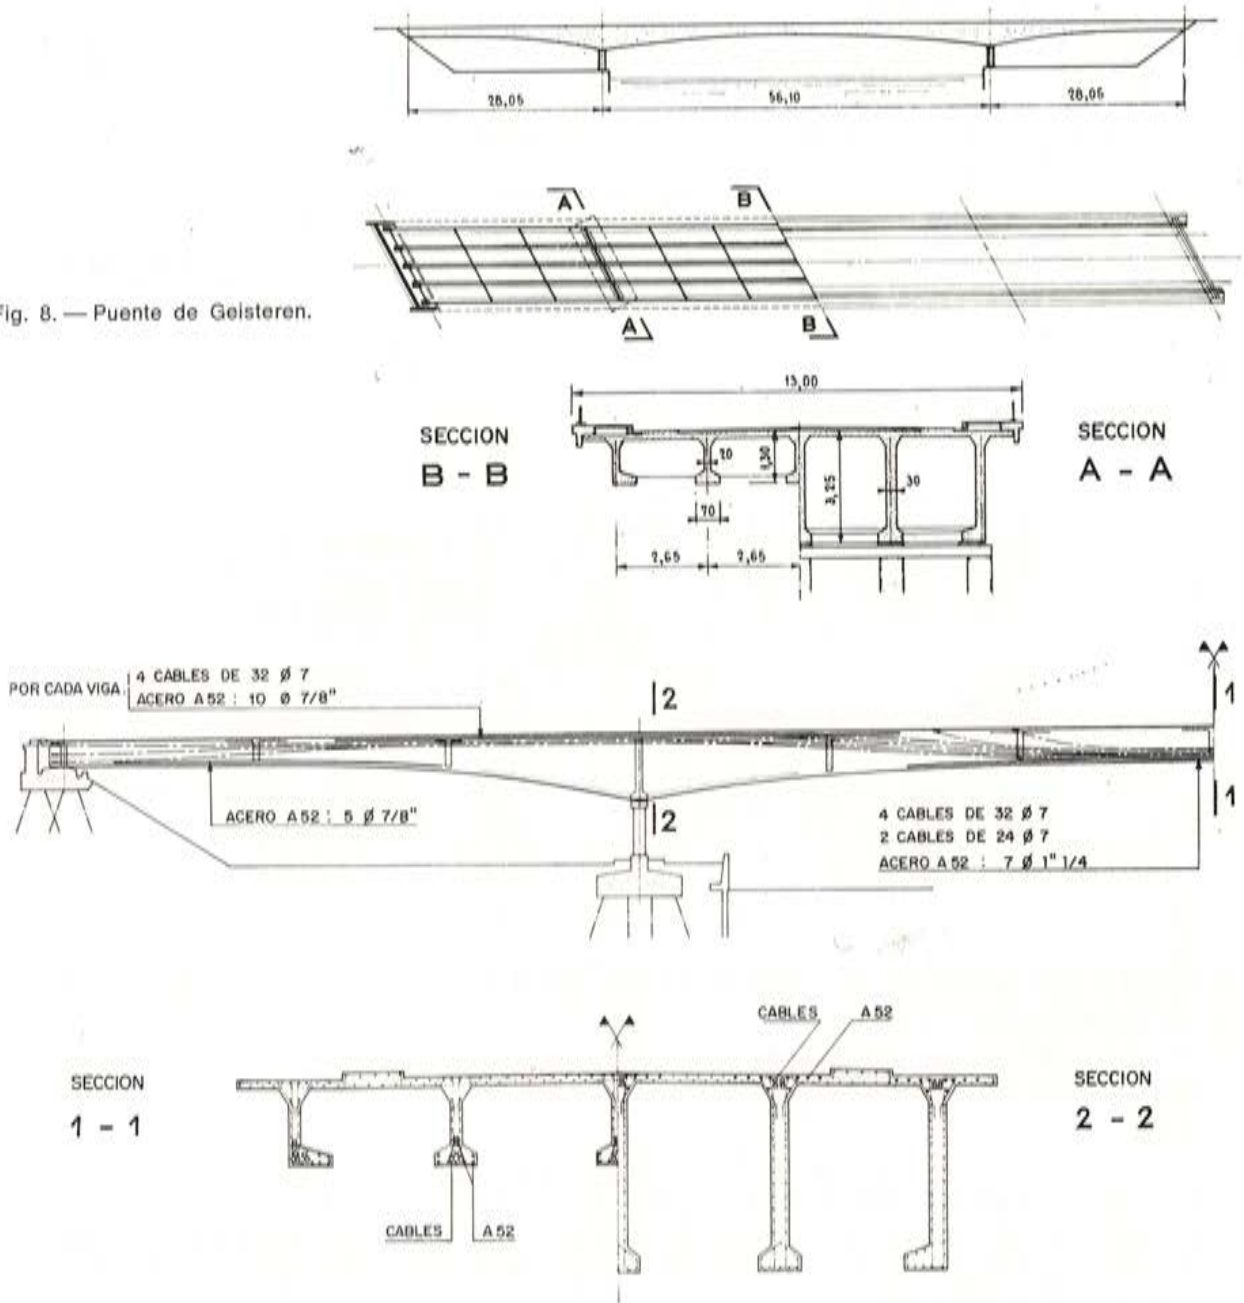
Puente de Geisteren. Trazado de cables y distribución de armaduras.
